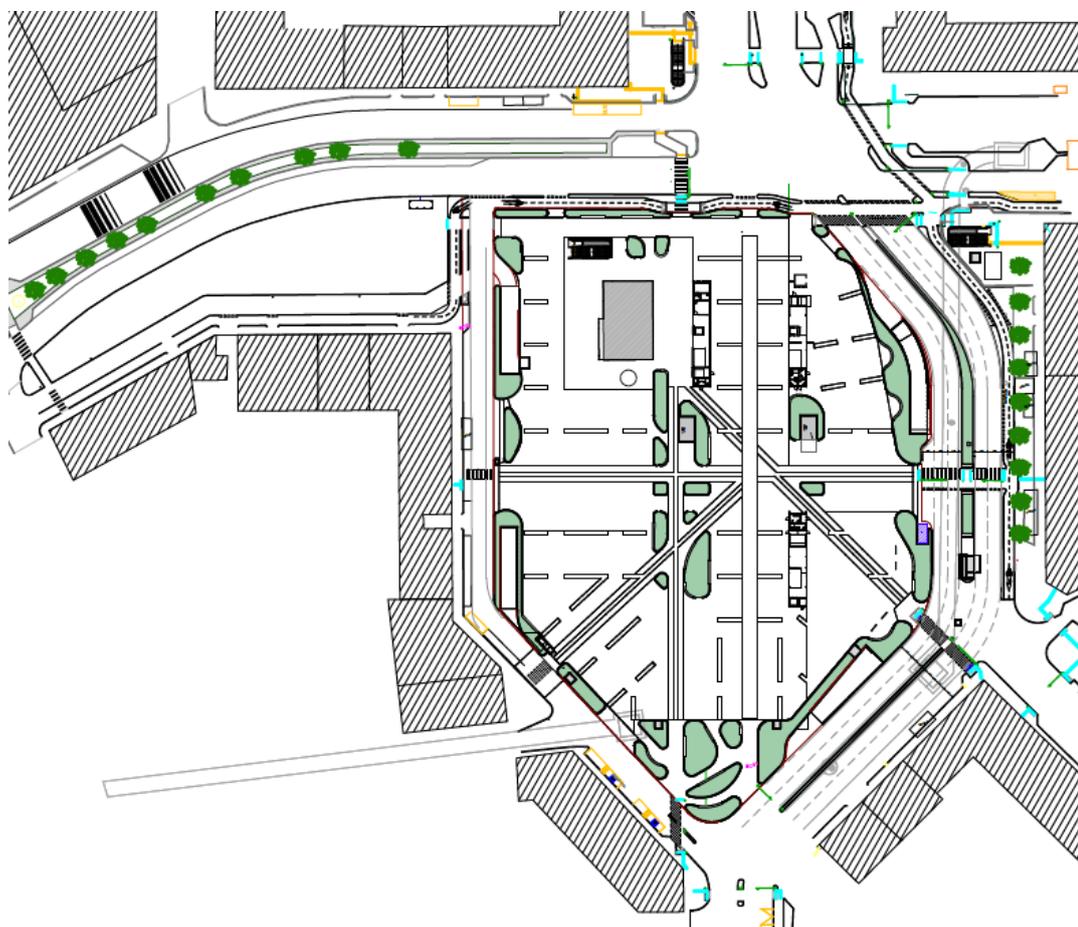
Planimetria generale dell'intervento di sistemazione superficiale
